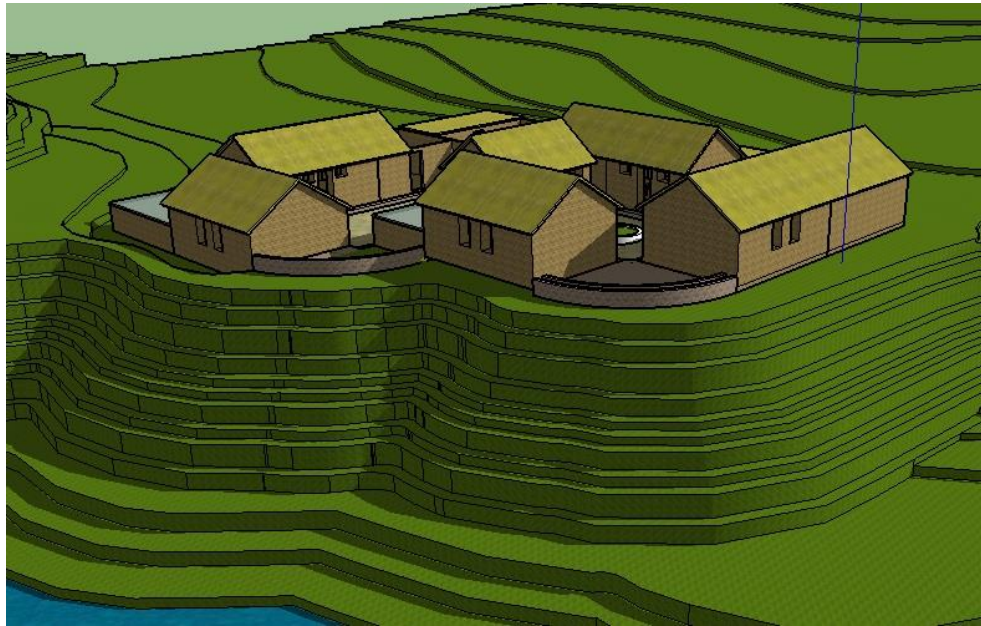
VISTA LATERAL AEREA OESTE – Fuente: propia
